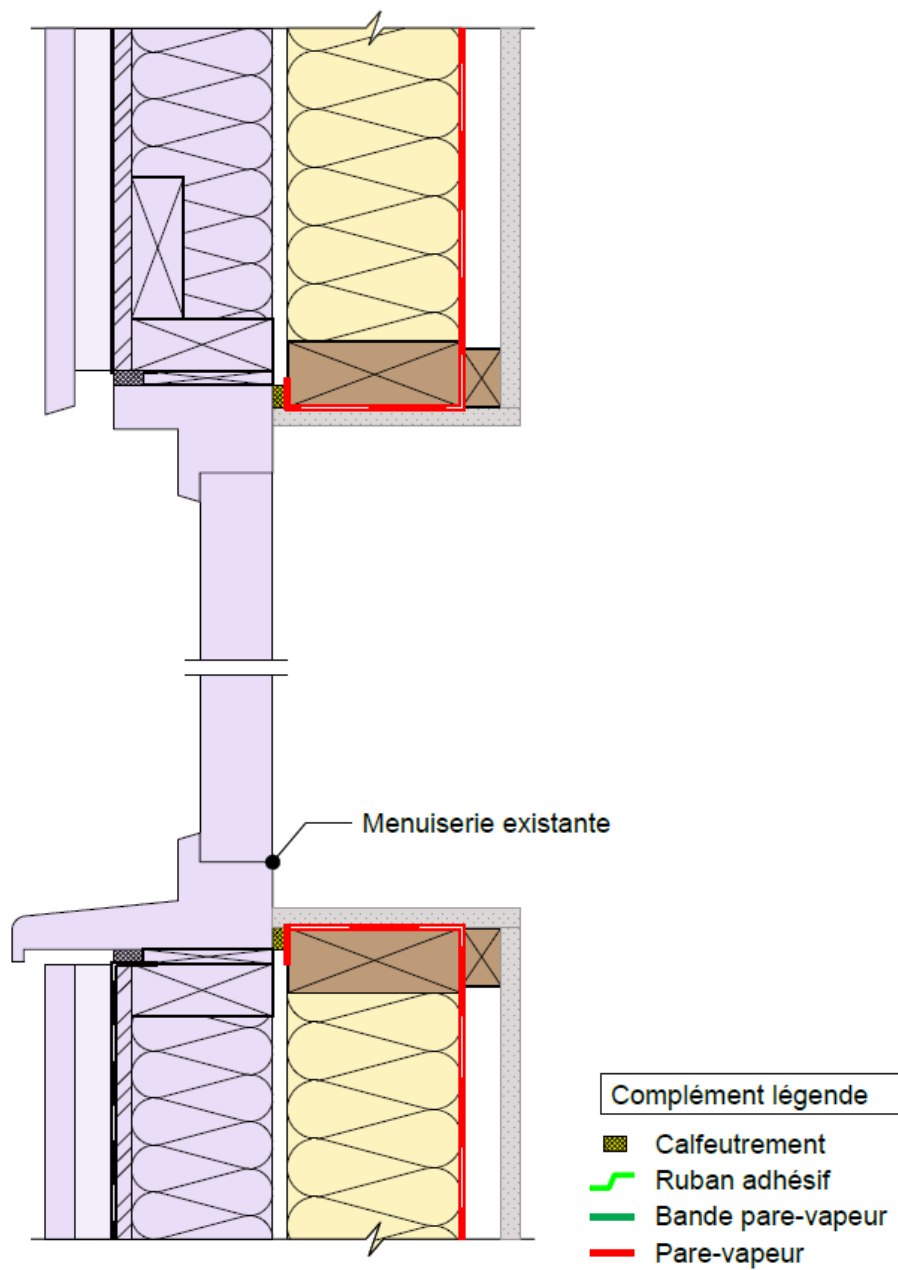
Baie avec conservation de la menuiserie existante (coupe verticale)
